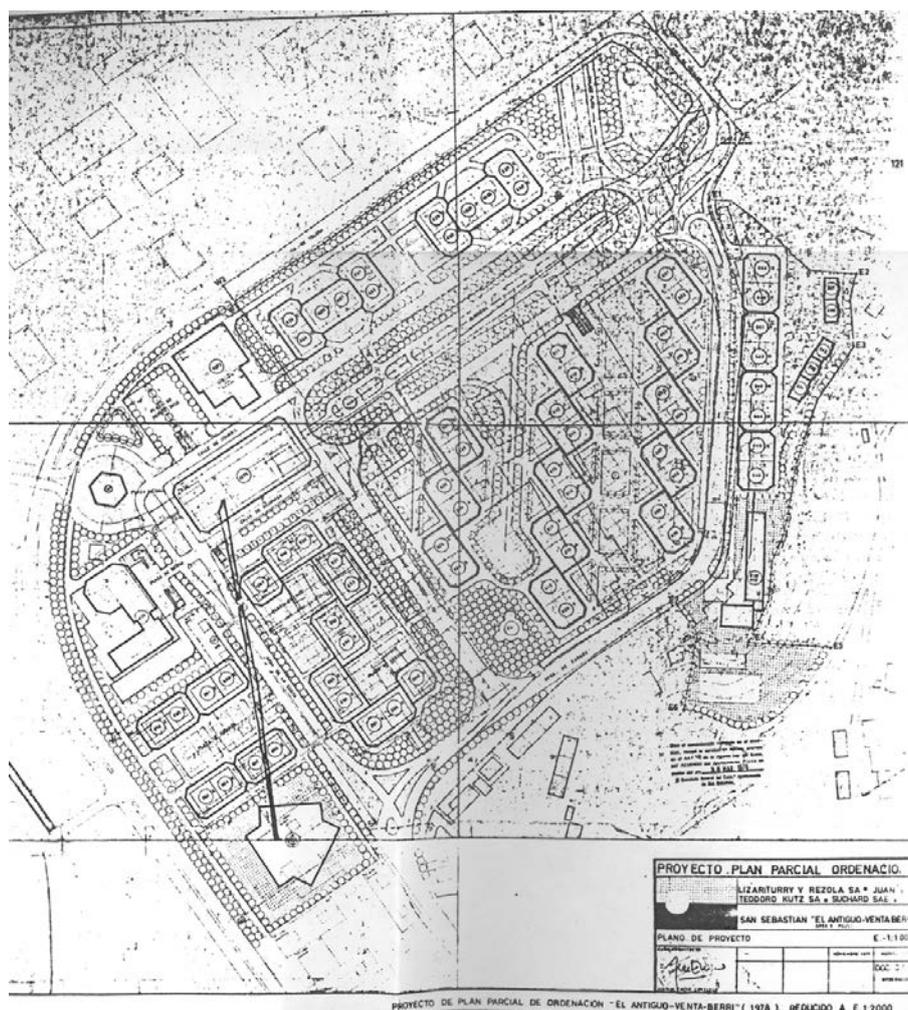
Plano de Proyecto de Plan Parcial de Ordenación -El Antiguo-Venta Berri- 1978 - Encío Cortazar - I.A.M.. Pág. 121
